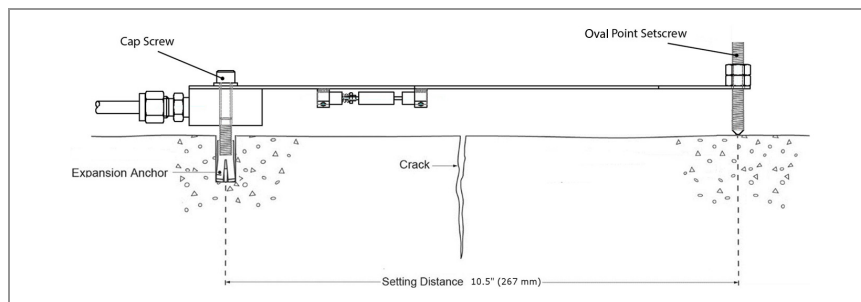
Ensamblaje del medidor de grietas con un solo anclaje y sin disco de referencia
